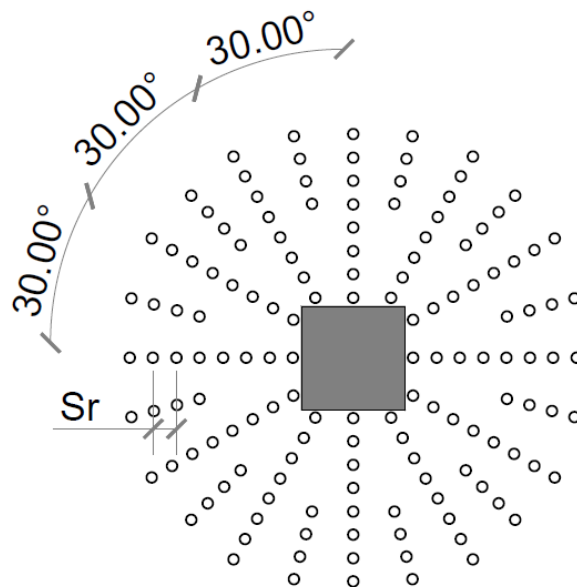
Detalhe da armadura de cisalhamento das lajes compostas por oito camadas de *studs
